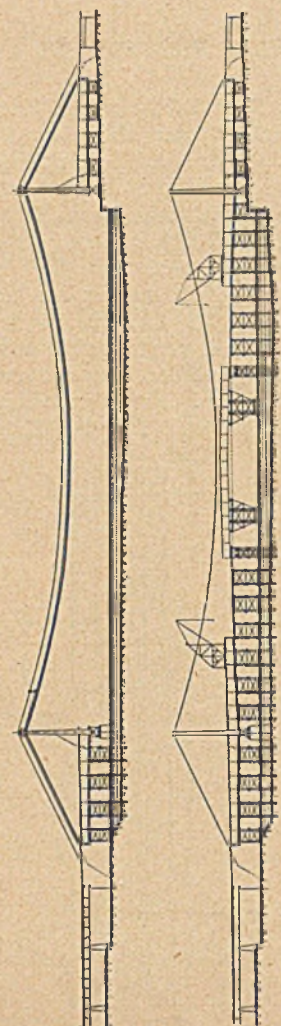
„Welstadt“. Entwurf I. Aufstellungsplan.
